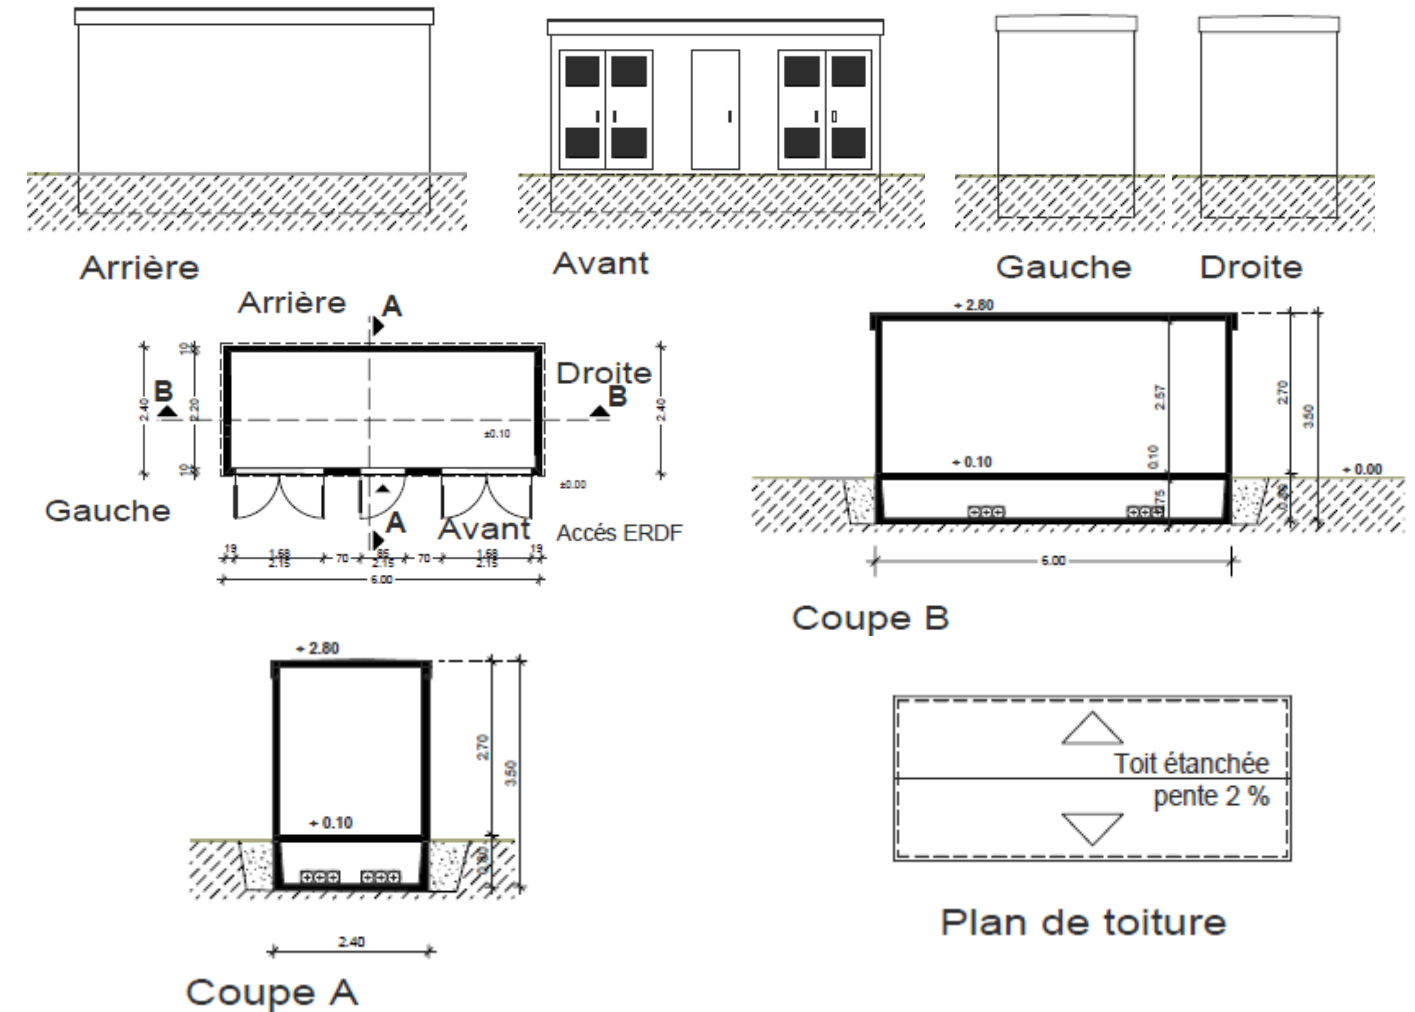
Plan, coupe et élévation du poste transformateur prévu sur site (source : AD Agence)
